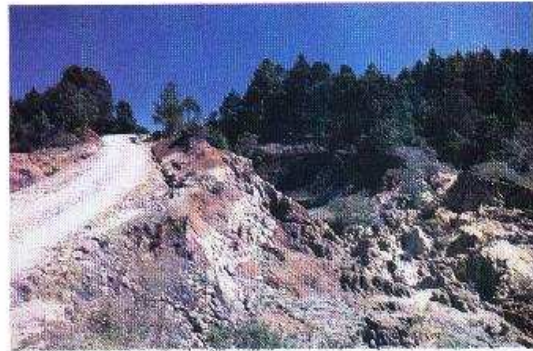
Un ejemplo de erosión en cárcava severa en un camino rural como consecuencia de un trabajo mal hecho y drenajes inadecuados. Quetzaltenango, Guatemala. (Foto G. Bauer)
